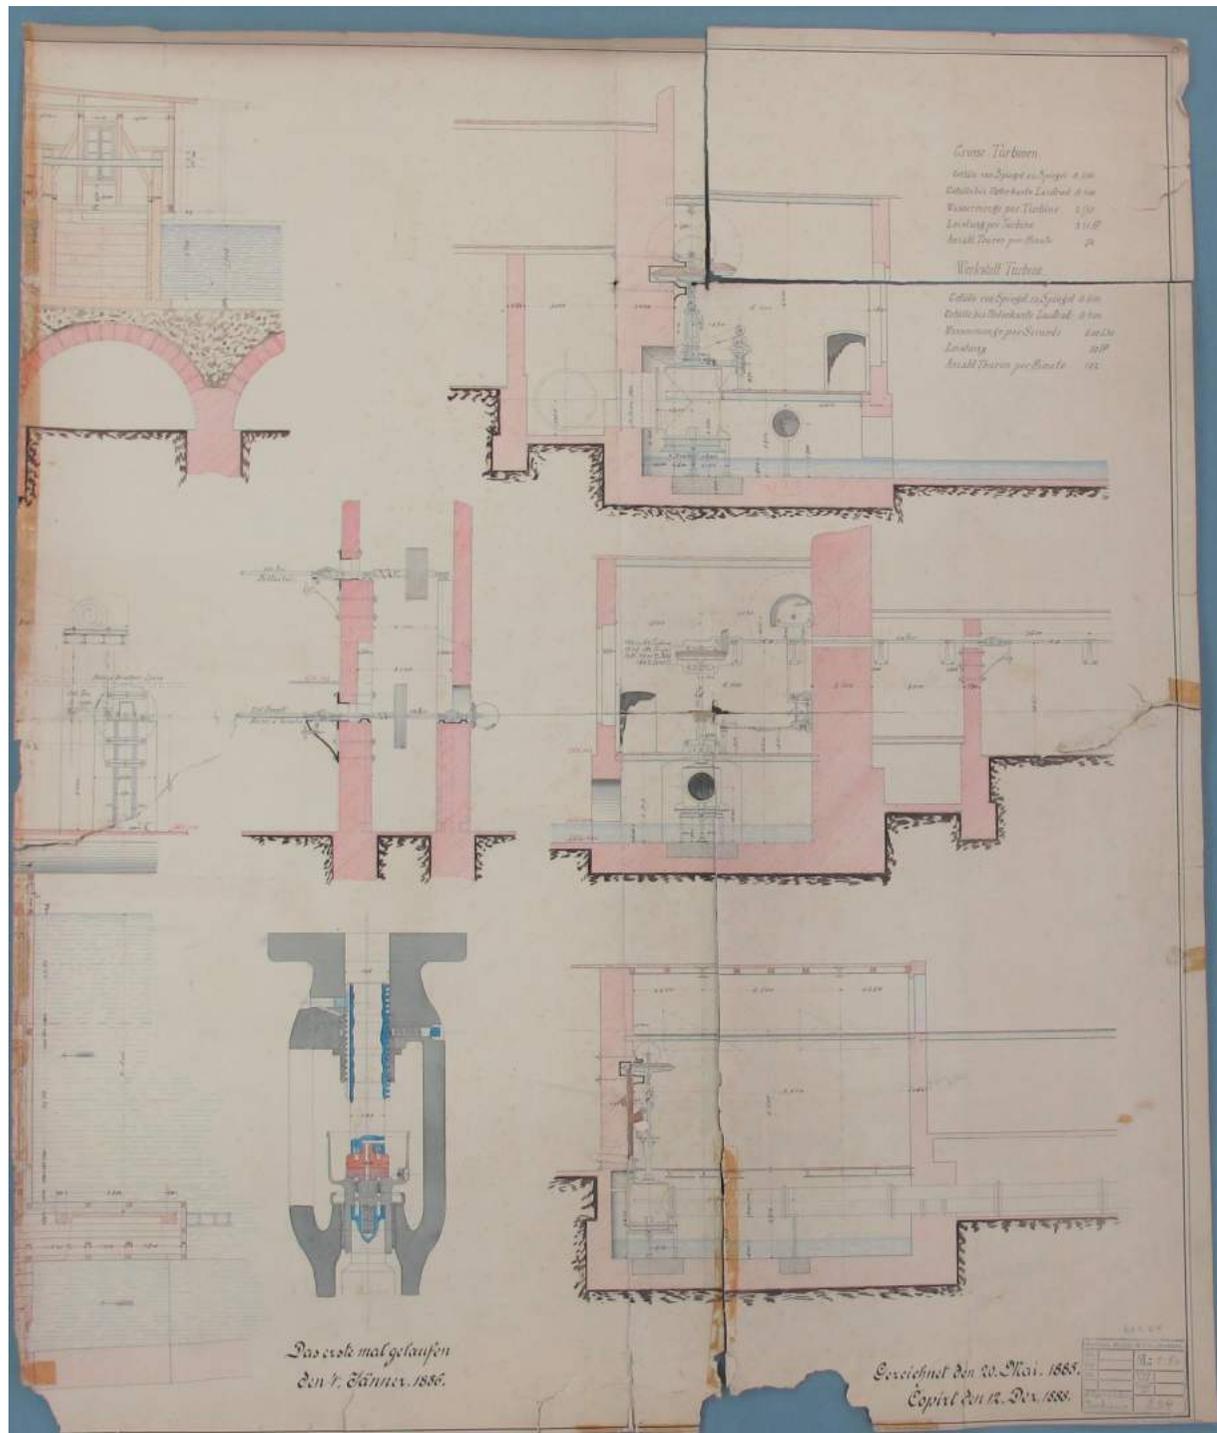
Plan Seilgang (Transmission), Grundriss und Querschnitt, handschriftliche Anmerkungen, Jahr unbekannt
